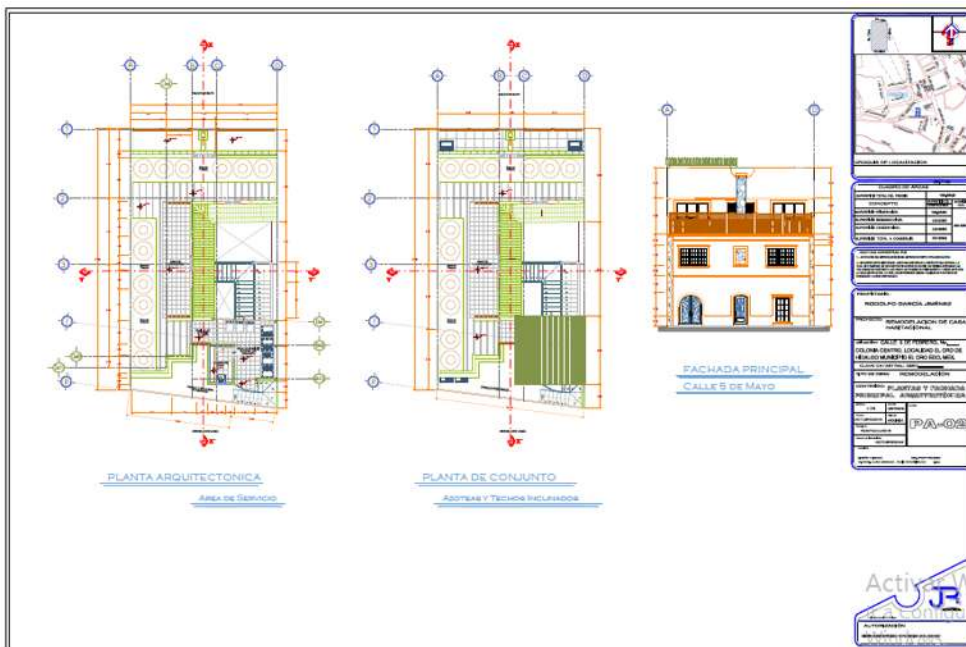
Imagen del Segundo Plano Arquitectónico en él, se indica la Planta de servicio, la cual corresponde a el área de servicio de lavado, donde se encuentra los espacios para albergar lavadoras, secadoras y lavaderos convencionales, con su respectivo área de tendedores. Además queda presente la ubicación de la escalera servicio, la cual se ubica en la parte posterior del proyecto y muy importante la Planta de Azoteas del conjunto.
